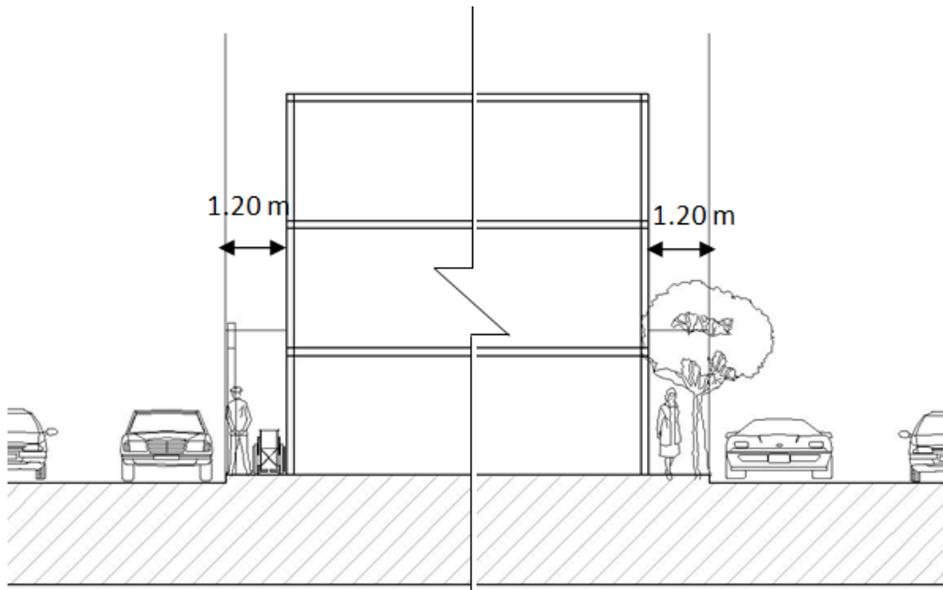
Corte esquemático con banquetas de 1.20 m de ancho. Fuente: elaboración propia.
